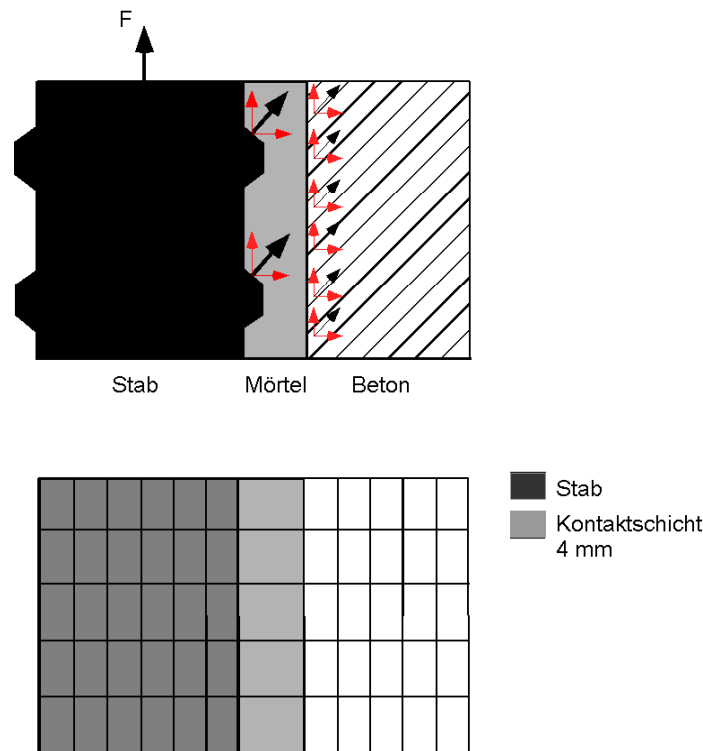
Nachträglich eingemörtelter Bewehrungsstab und FE-Modell mit Kontaktschicht zur Simulation des eingemörtelten Bewehrungsstabes
